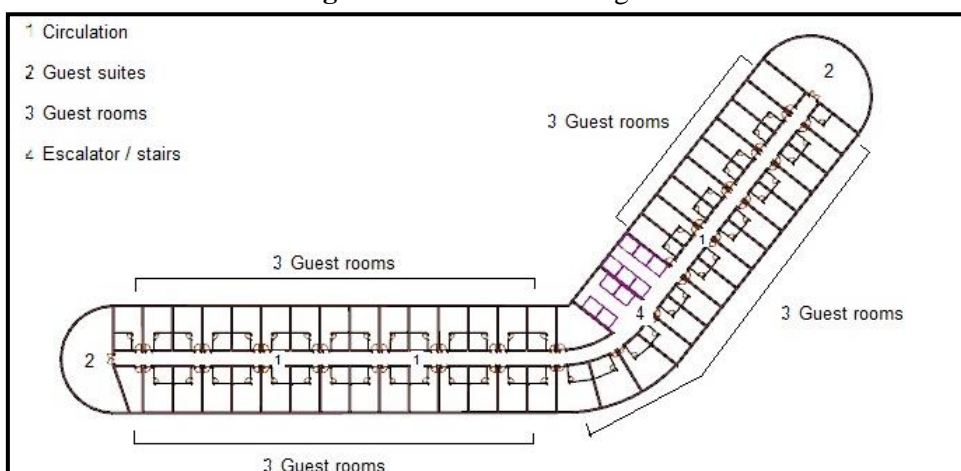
Plan du 4<sup>ème</sup> – 22<sup>ème</sup> étage Hôtel Omni Dallas
